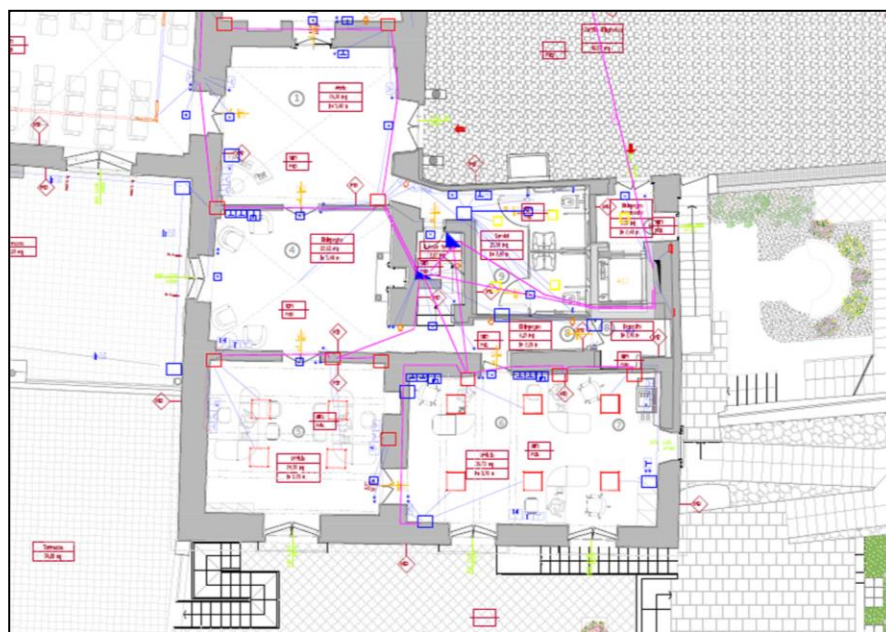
Impianto elettrico: pianta a q 0.00 - Stralcio zona uffici
